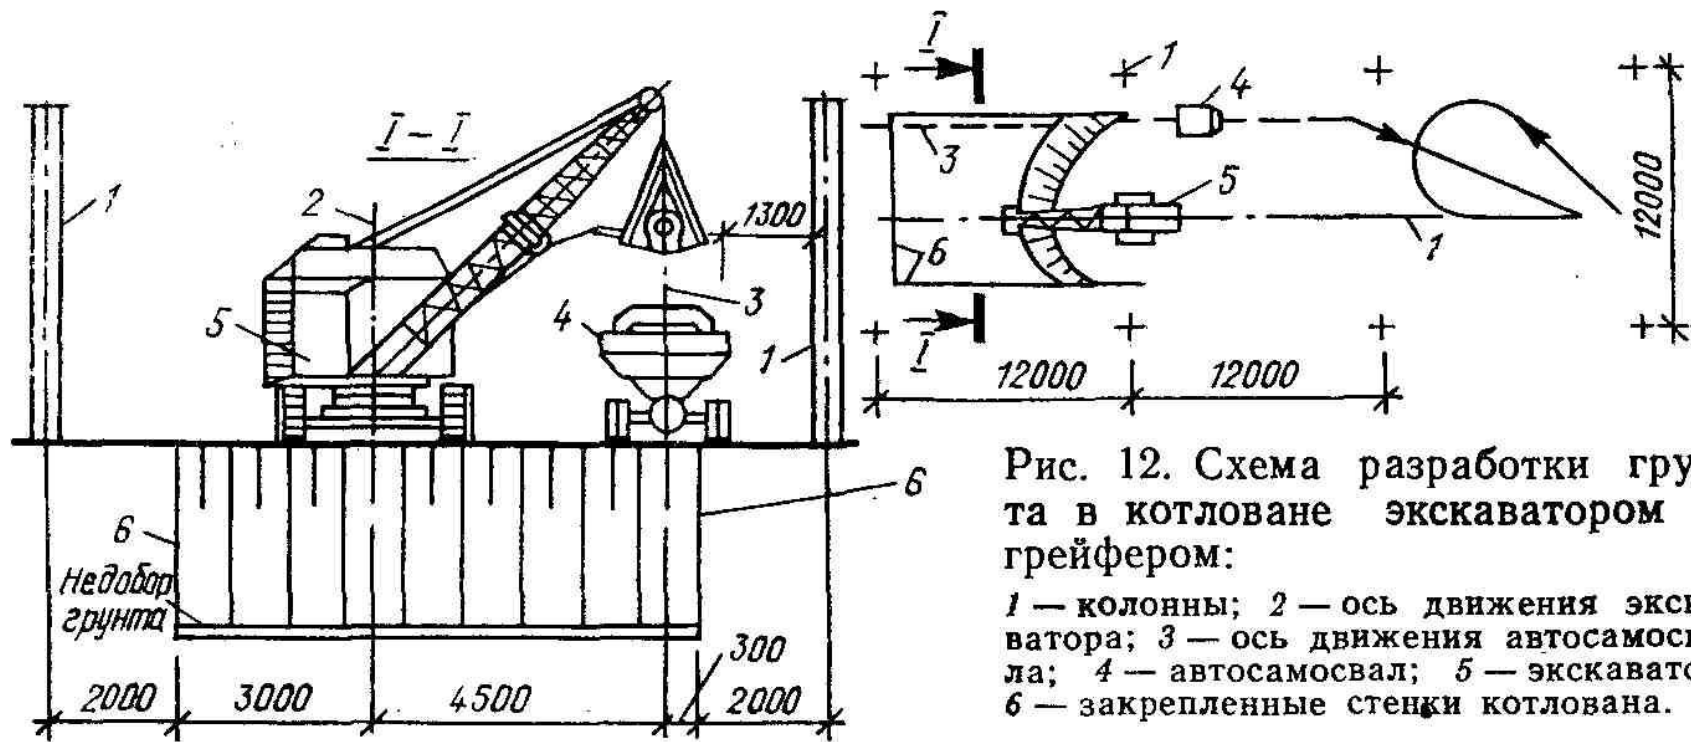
Схема разработки грунта в котловане экскаватором с грейфером:
